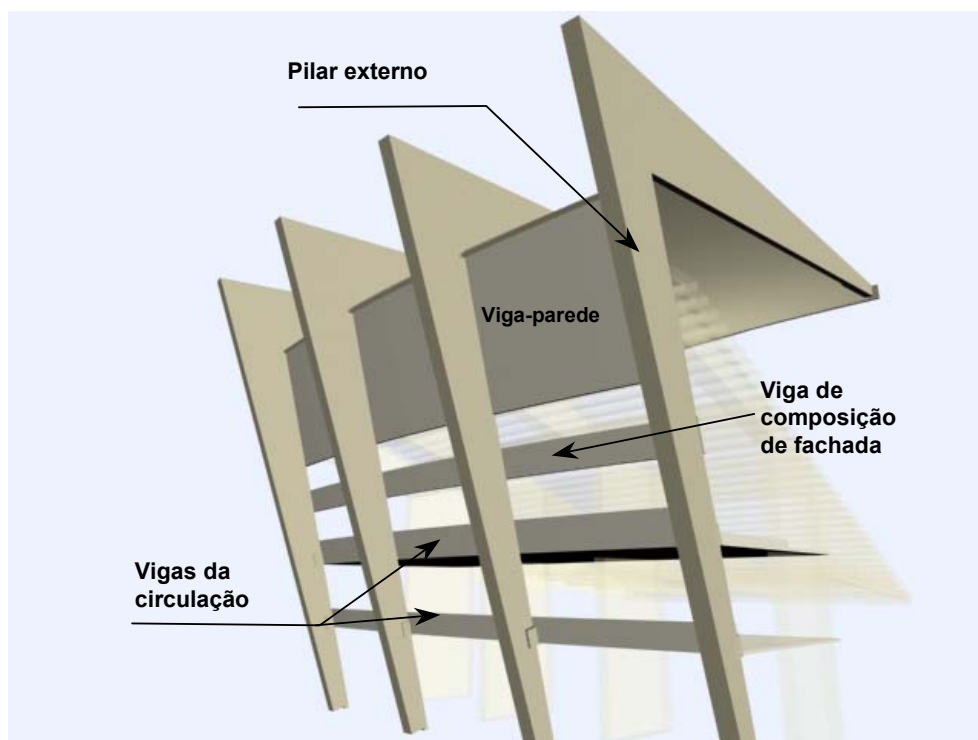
Croquis da estrutura mostrando pilares externos, as vigas-parede, vigas de composição da fachada e vigas da circulação
